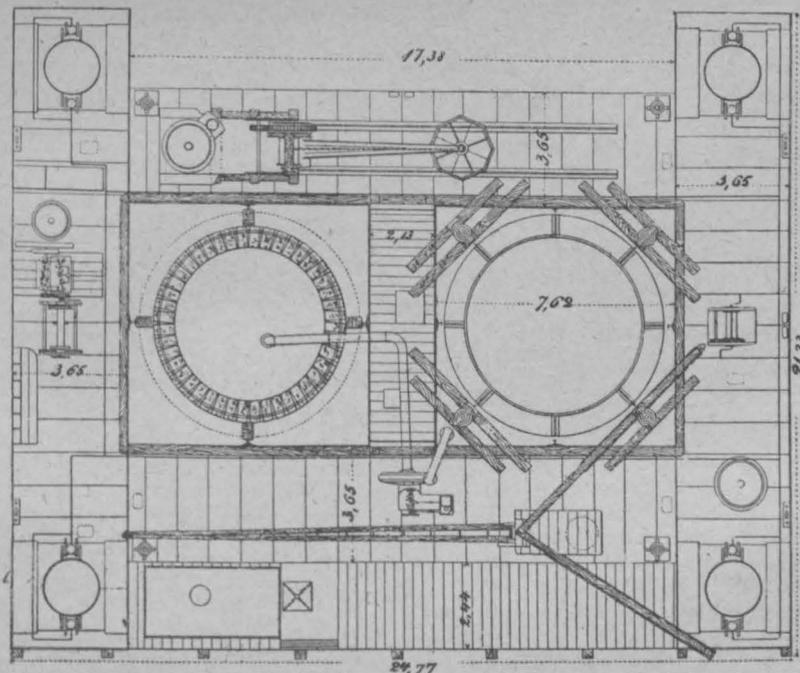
Grundriss eines Doppelpfeilers.
